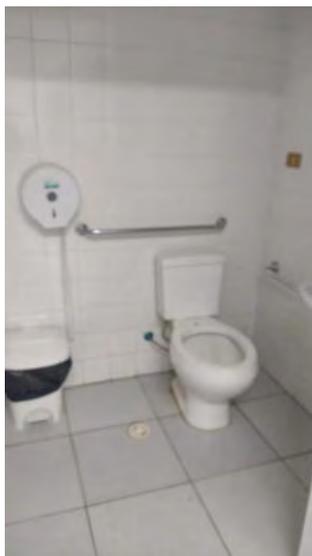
Vista do lavatório com barras de apoio
